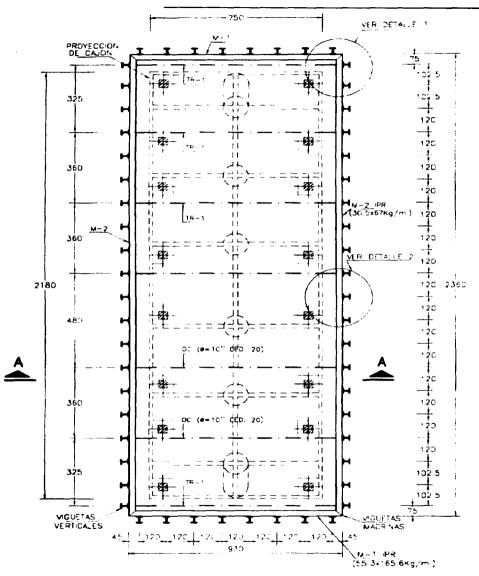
27 DETALLES DEL TROQUELAMIENTO DEL CAJON TIPO 1
